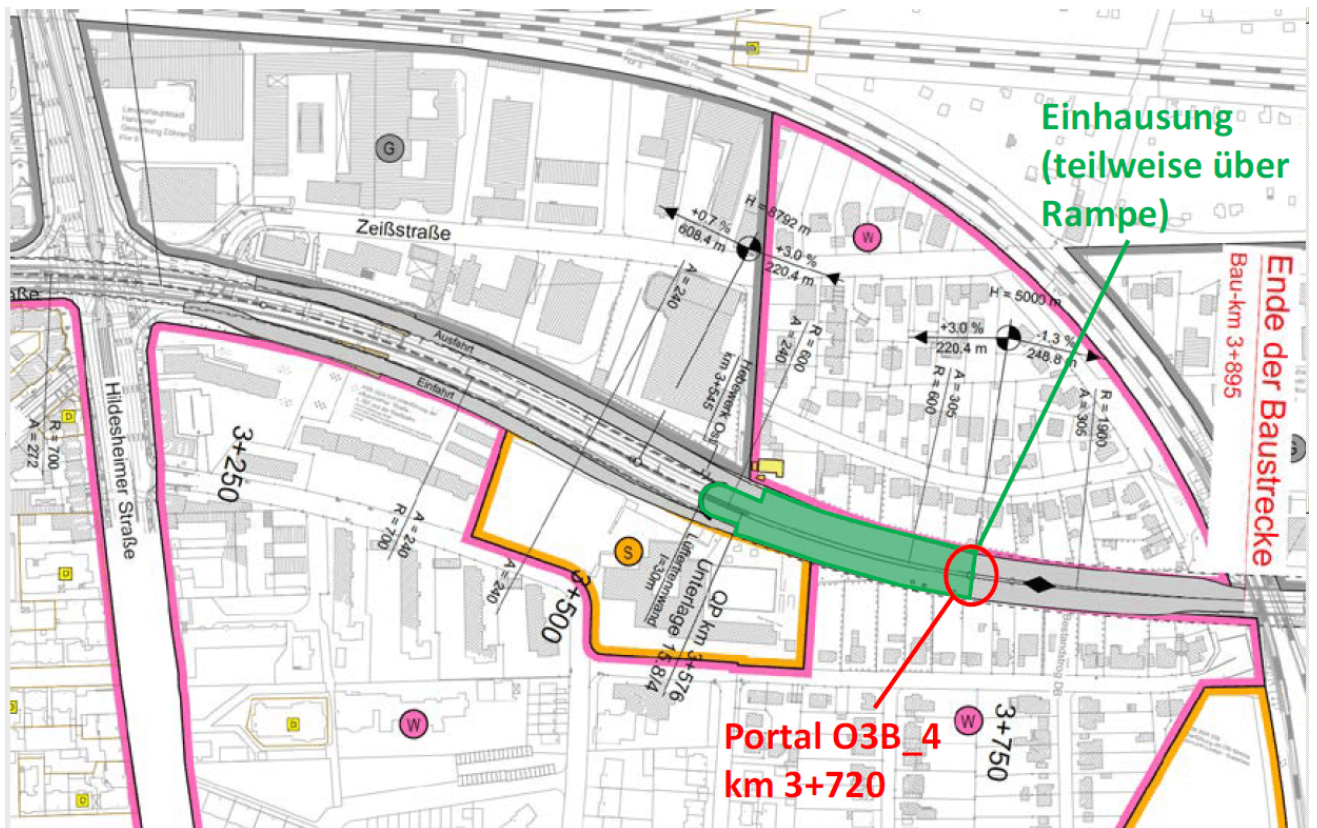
Lageplanskizze Planvariante O3B_4 [20].
